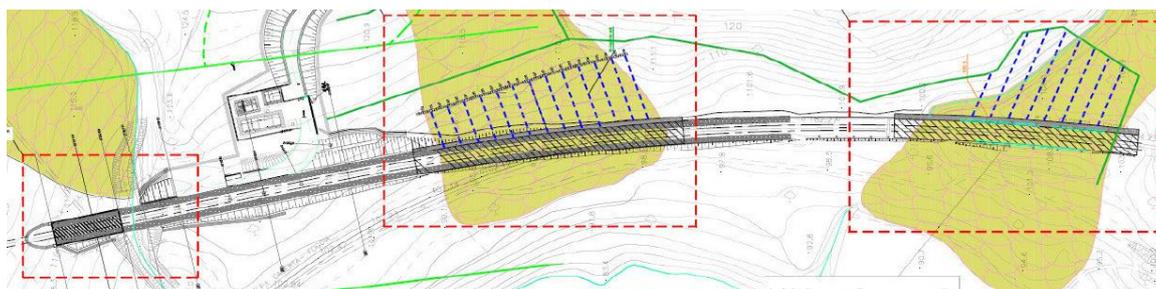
Contesto di analisi C - Stralcio planimetrico PE
